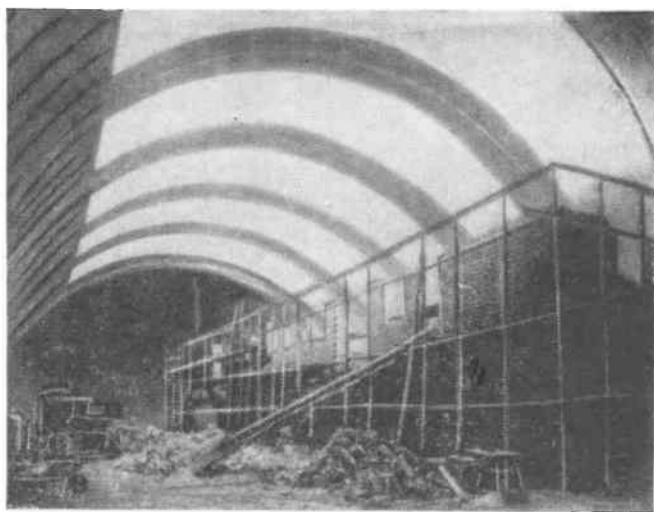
Временное перекрытие пневматической конструкции над строительной площадкой для ведения работ в зимнее время
